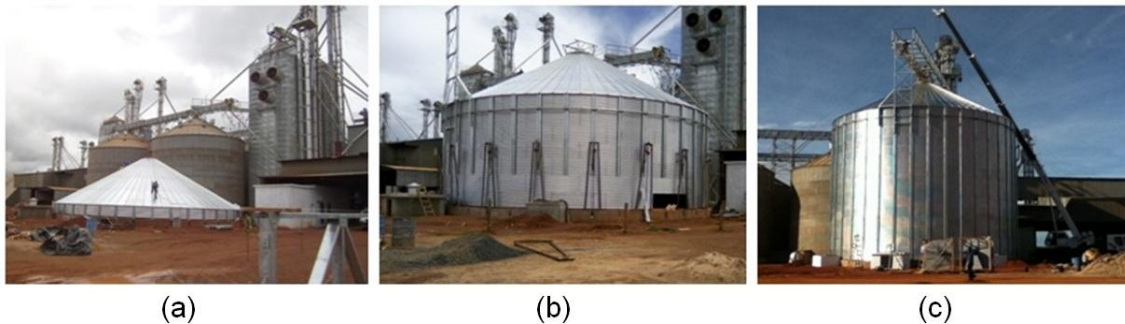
Montagem do silo pulmão na sede GO, iniciada pelo telhado (a); elevação e colocação das chapas (b); silo completamente estruturado (c).
